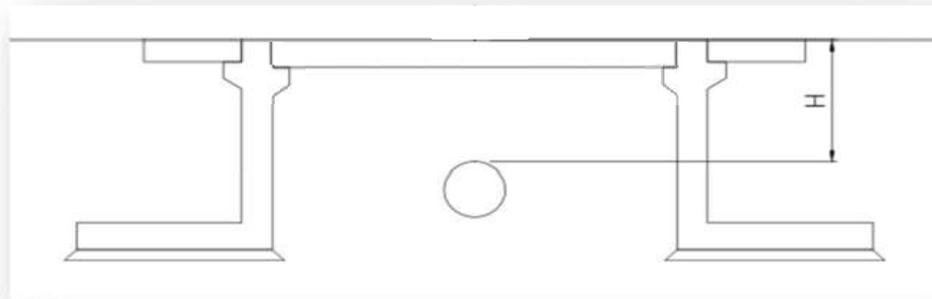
Esquema referencial de estructuración cajón de protección Gasoducto. Losa superior desmontable.
